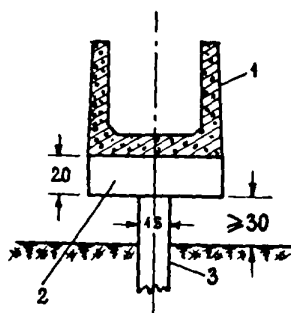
Водоотводящий лоток на грунтах IУ категории: 1 - звено лотка; 2 - насадка; 3 - свая
